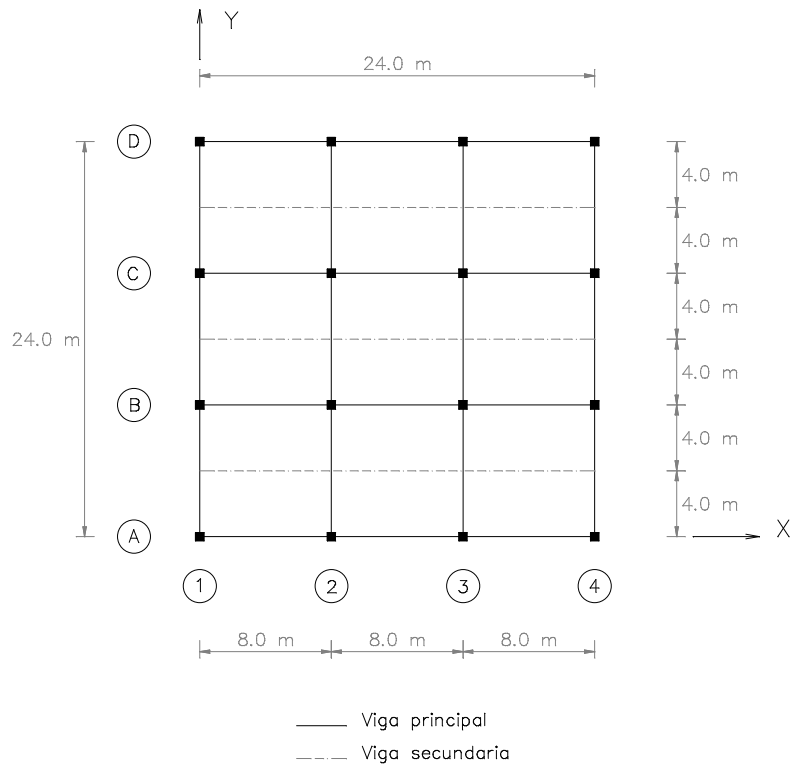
Planta tipo, edificios de 7 y 17 niveles
